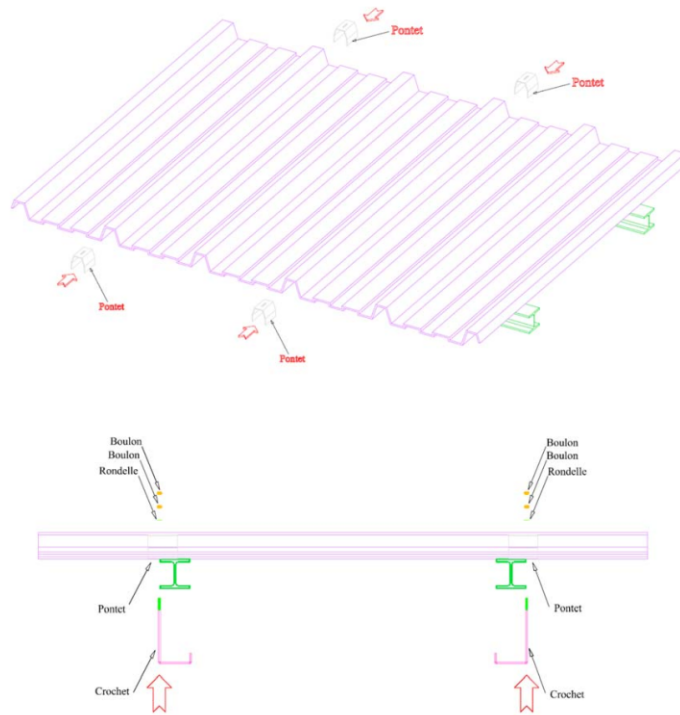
Support aluminium : mise en œuvre sur toiture plaque nervurée avec pontet
